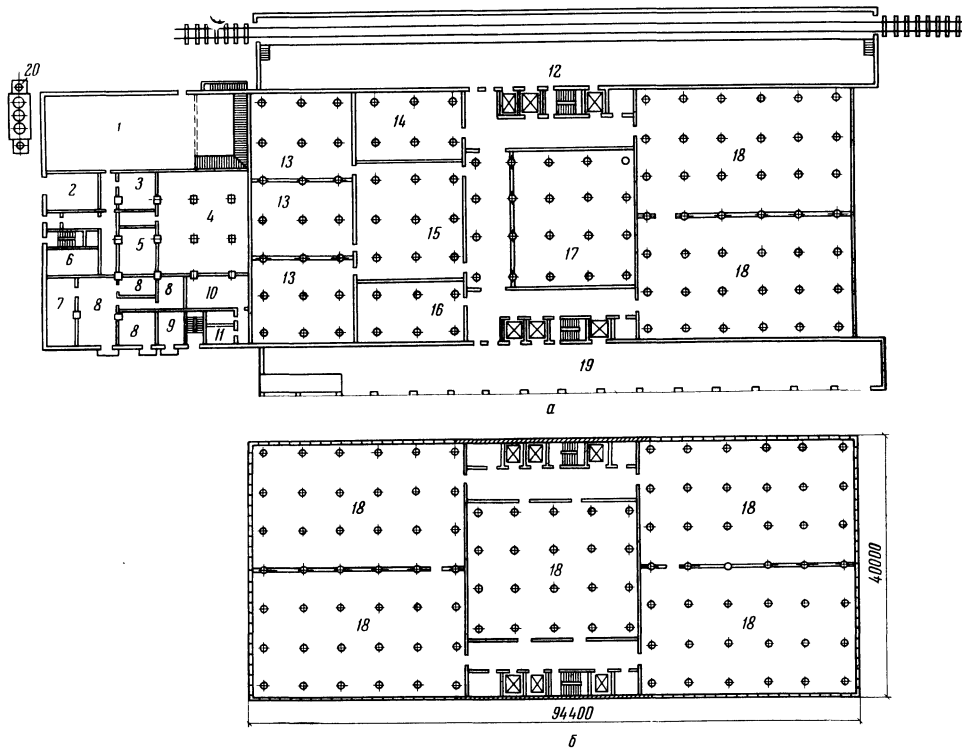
Планы: а — первого этажа; б — наземных этажей;
